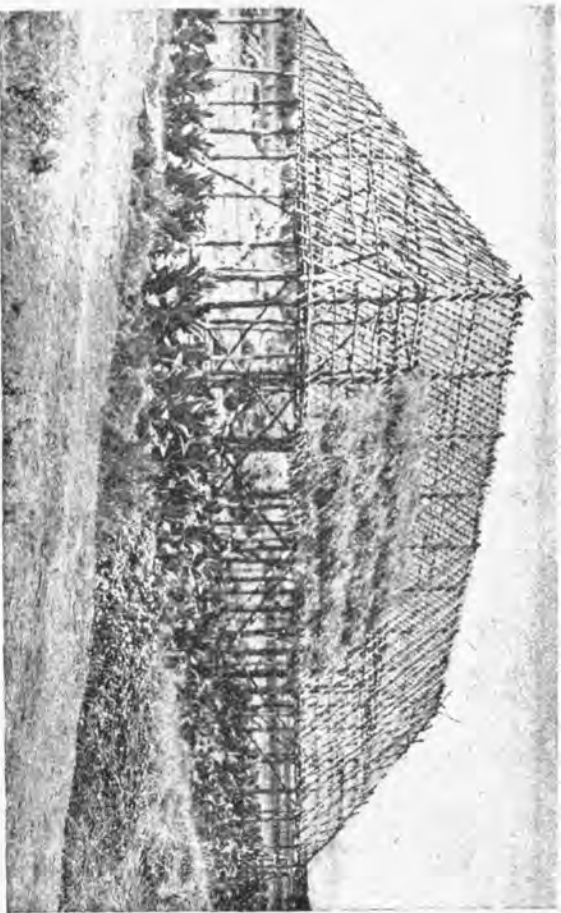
Esqueleto, detalle de la armadura de cubierta de madera rolliza de chopo, y aspecto exterior una vez recubierto con los empajados, de un secadero, con el que por la fuerte pendiente de la cubierta y el aislamiento del medio exterior proporcionado, por la gruesa capa de paja, se obtienen positivos resultados en algunos términos municipales de la vega de Granada.
